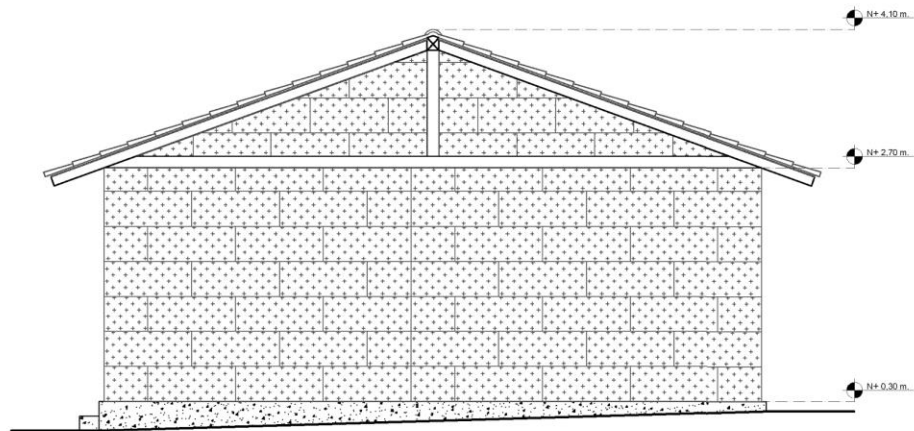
Fardos de paja aplicados en planta arquitectónica de caso de estudio.
